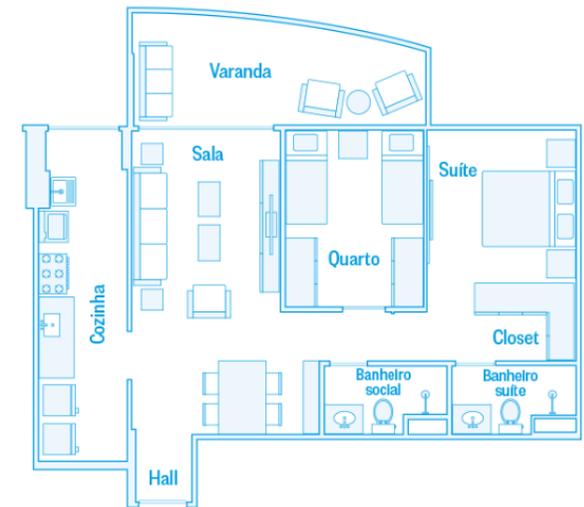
Planta baixa anos 2000. (Fonte: Blog da arquitetura)
